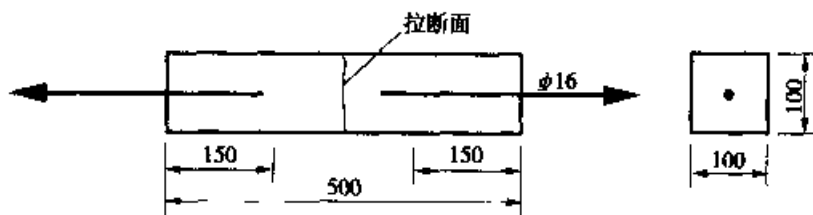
混凝土直接受拉试验(尺寸单位:mm)
